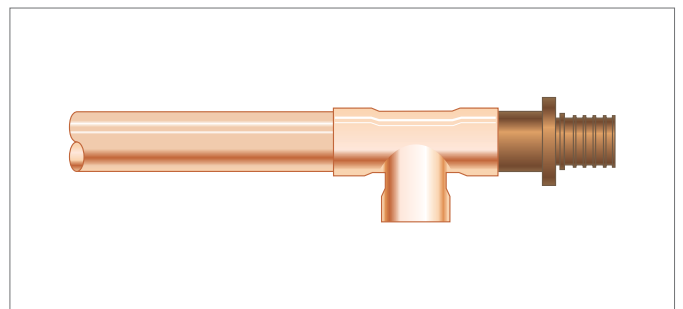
Racor fijo con rosca macho RAUTITAN RX soldado a un tubo de cobre
